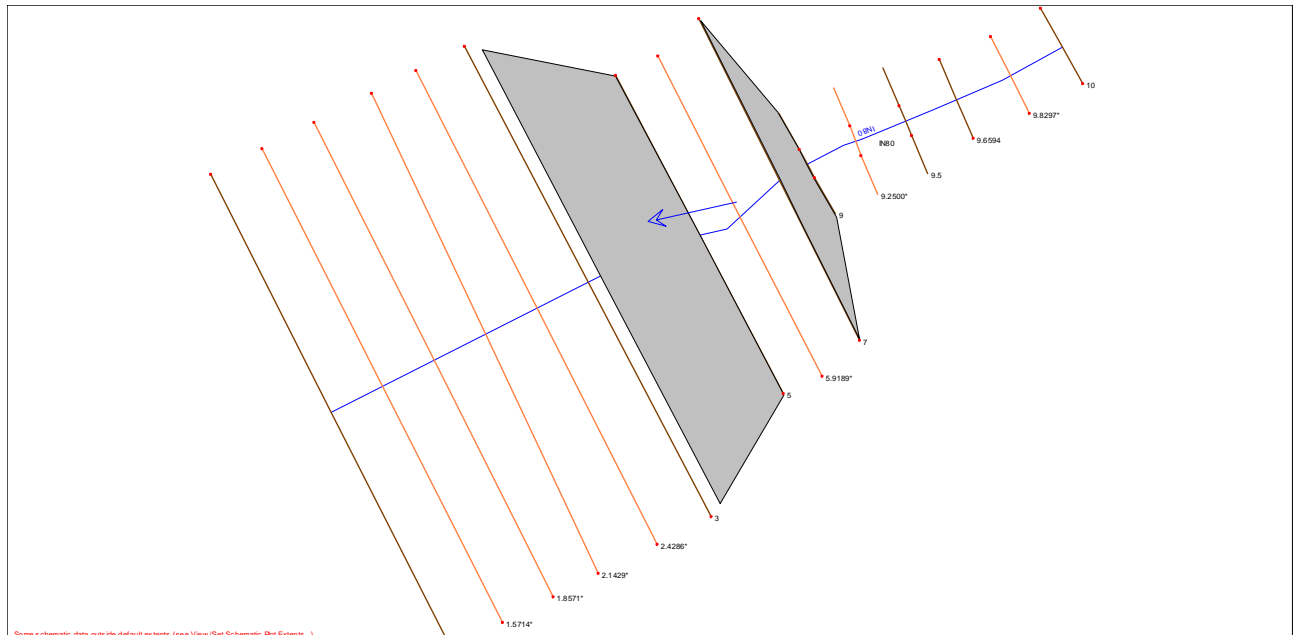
Planimetria modello 1D – stato di progetto interferenza IN80.
